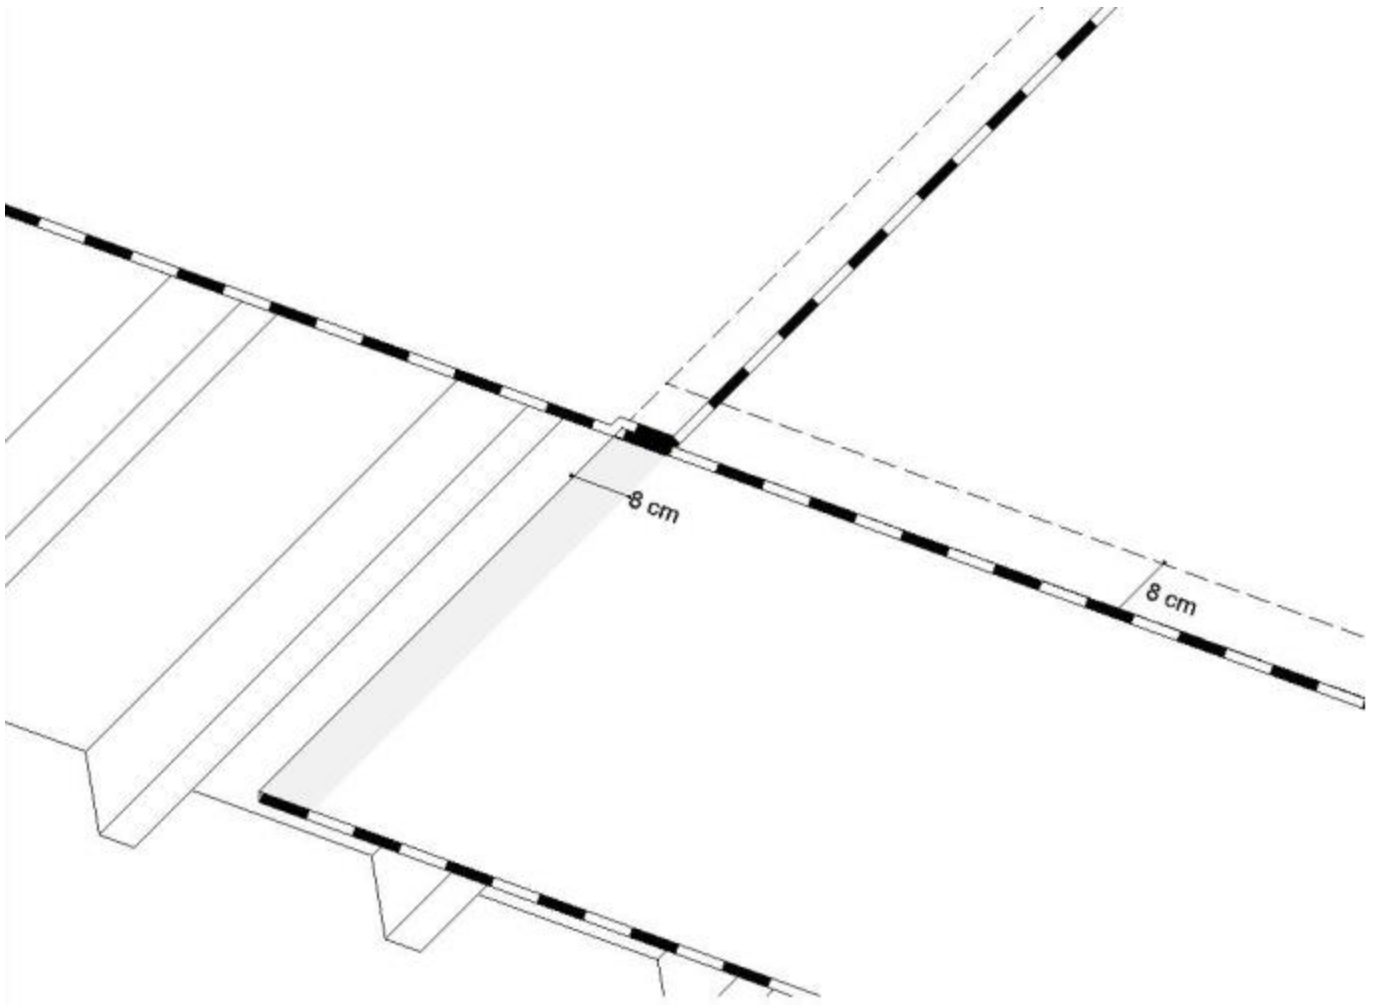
principe des recouvrements des pare-vapeur BauderTEC DBR et BauderTEC KSD
